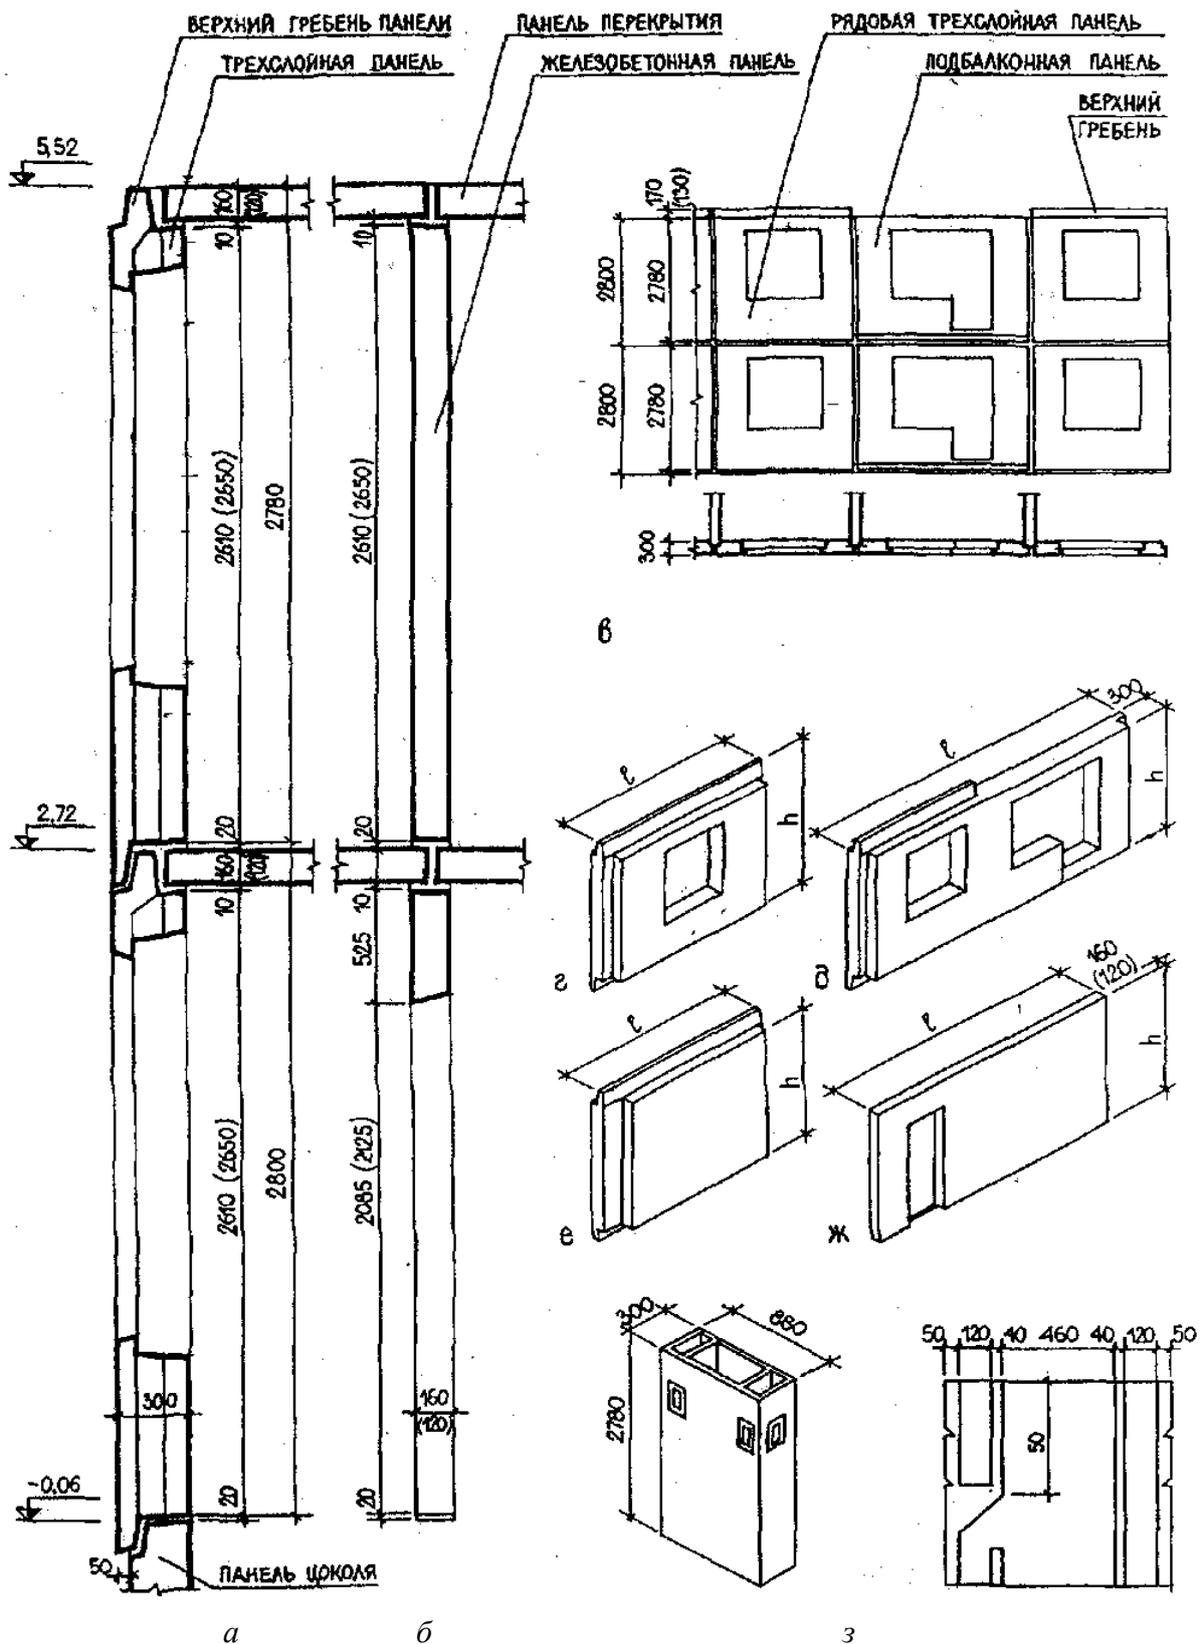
Основные железобетонные панели и стены из них: *а* — порядовка наружной стены из трехслойных панелей; *б* — порядовка внутренней стены; *в* — разрезка наружной стены из одношаговых трехслойных панелей; *г-е* — трехслойная панель наружной стены, рядовая одношаговая, подбалконная двушаговая, торцевая; *ж* — панель внутренней стены; *з* — вентиляционная панель
